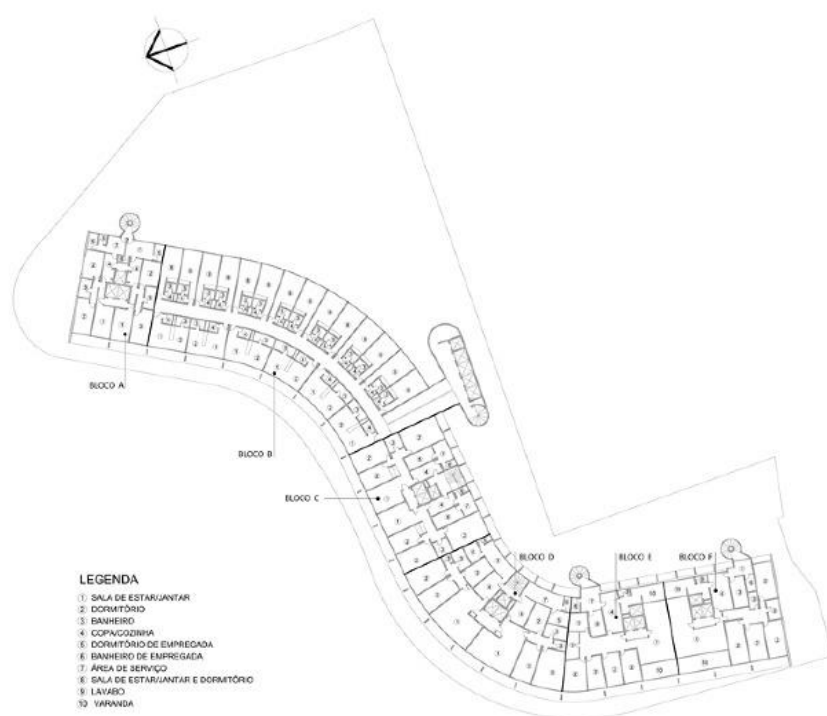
Planta baixa pavimento tipo do edifício Copan. (Fonte: [pinterest.com/pin/499195939916912694/](https://www.pinterest.com/pin/499195939916912694/))
